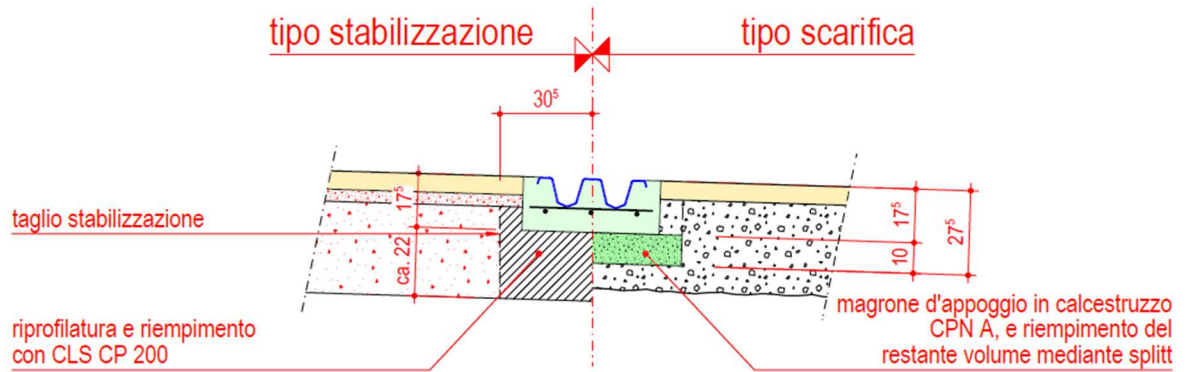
Sezione tipo nuove canalette nella pavimentazione in asfalto
